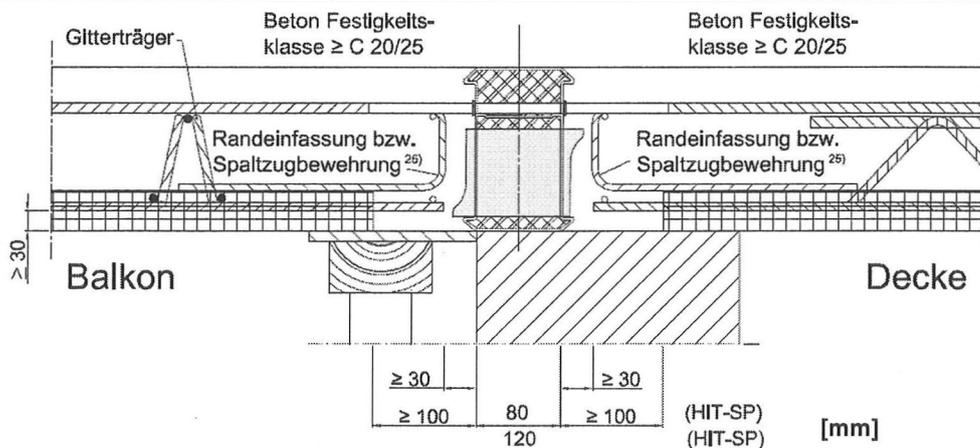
Beispiel für den Anschluss HIT-HP/SP MV F 120/REI 120 an Elementplatten mit statisch - wirksamer Ortbetonschicht
